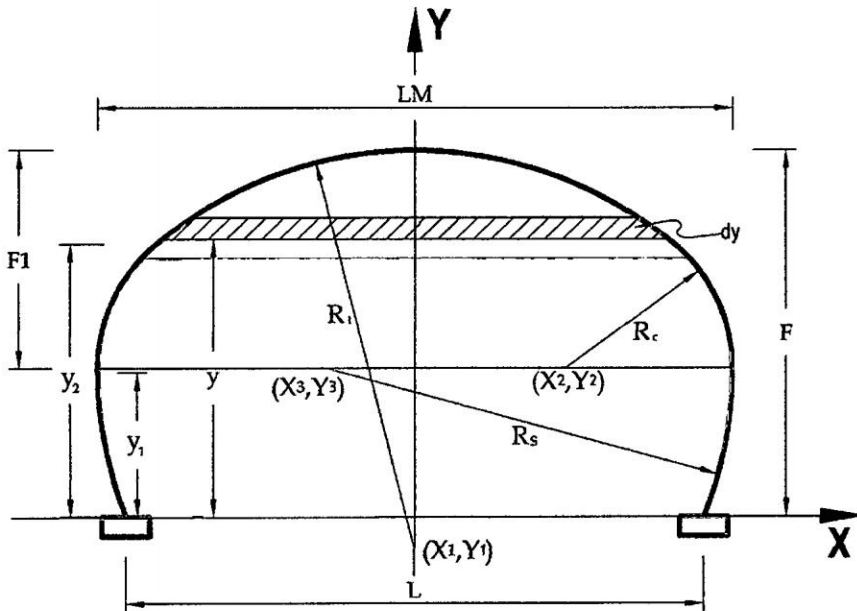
Alcantarilla de sección arco perfil alto. Fuente: *Elaboración propia
